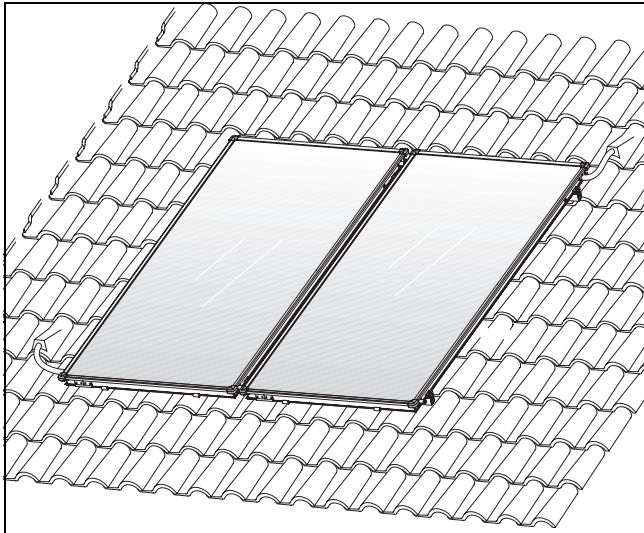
Imagen del montaje de los captadores sobre tejado inclinado
